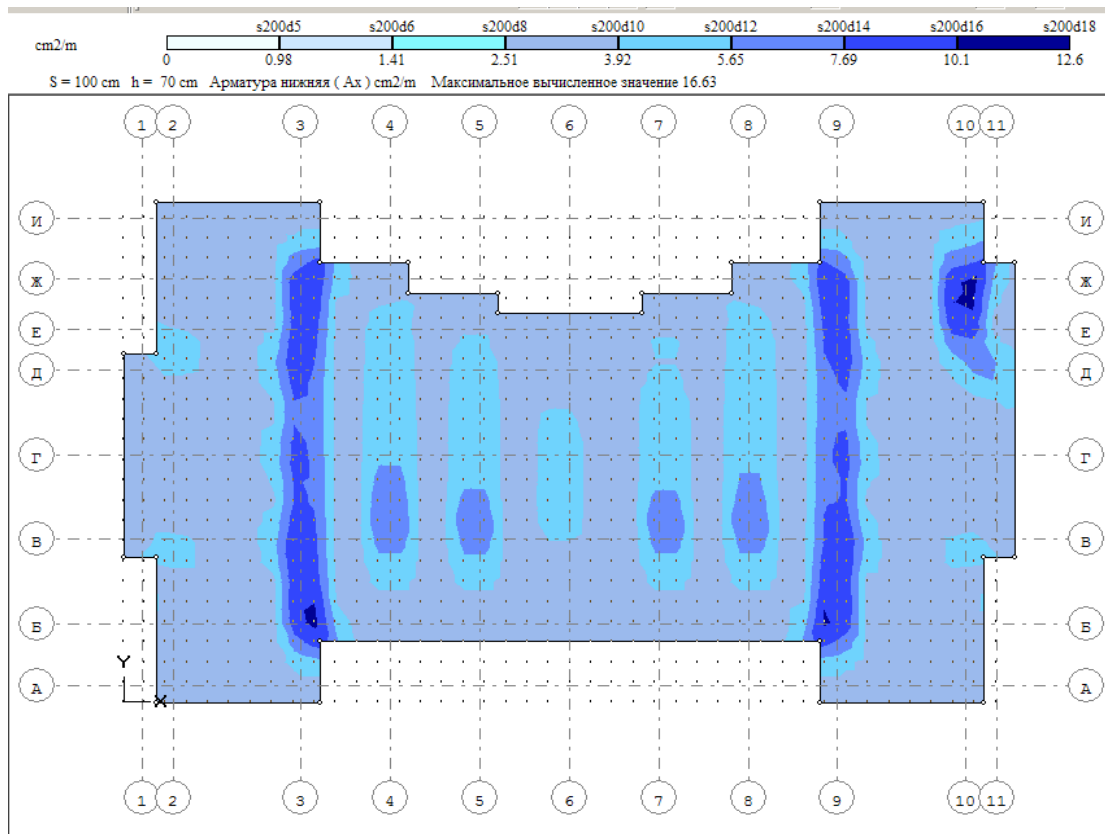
Мозаїка армування плити по осі X нижній пояс (до реконструкції)
